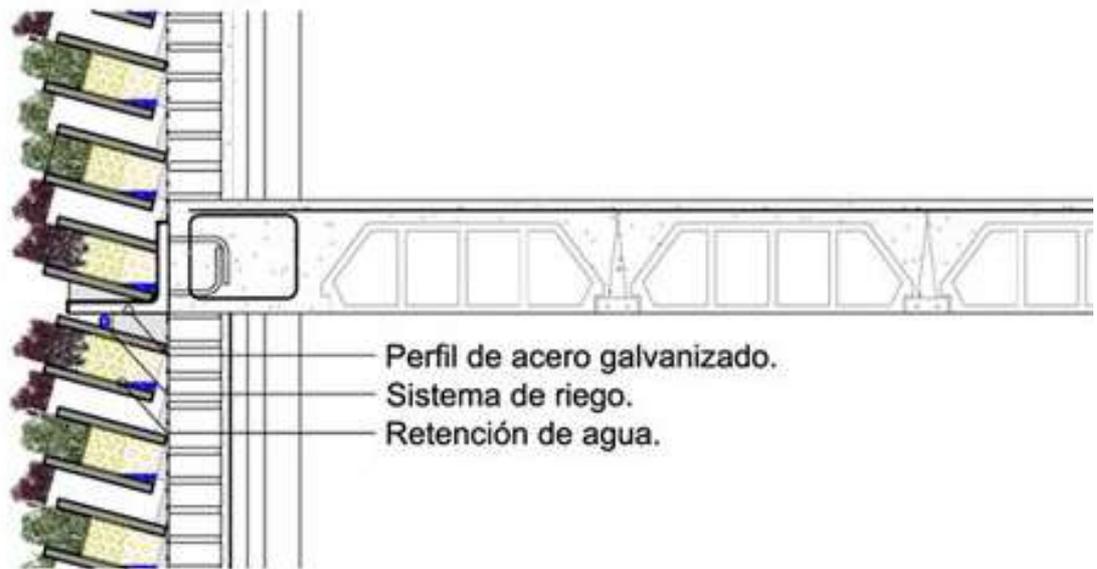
Detalle Fachada vegetal sistema Eco Bin.
